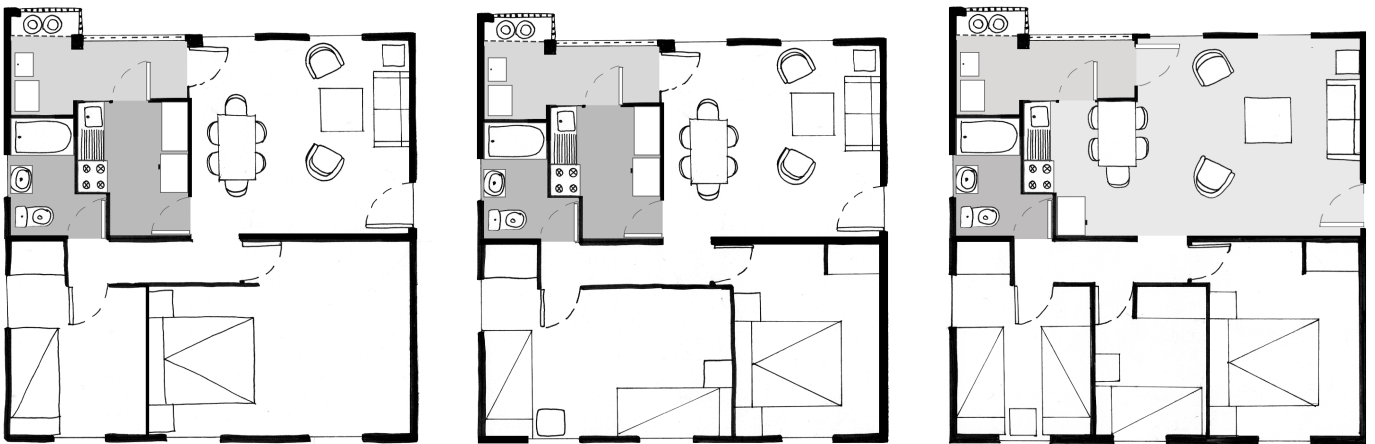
Flexibilidad vivienda tipo. Sin Escala. Elaboración Propia.
